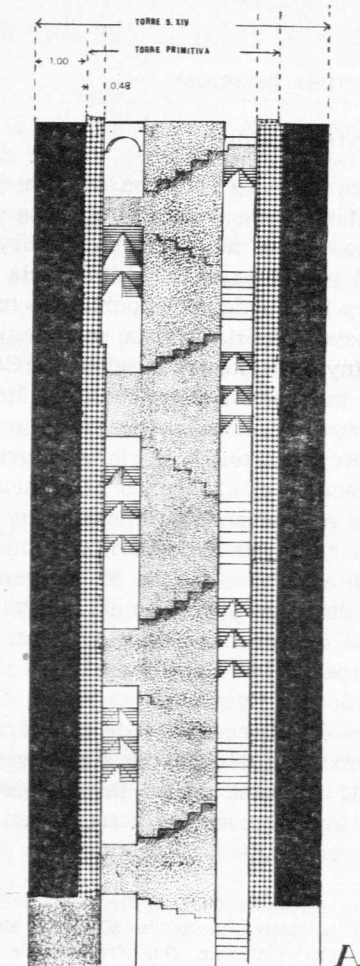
Torre de Santa María. Alzado y Sección. Ocaña.
